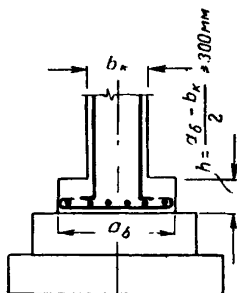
Опирание железобетонных колонн на бетонные и бутобетонные фундаменты
